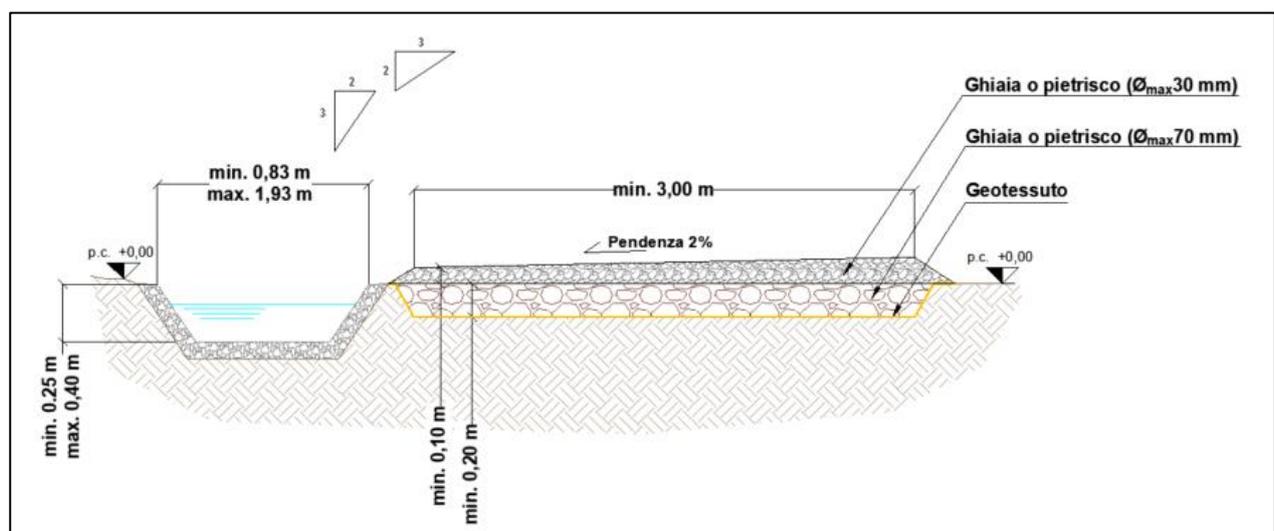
Tipologico sezione stradale viabilità interna con canaletta di drenaggio
